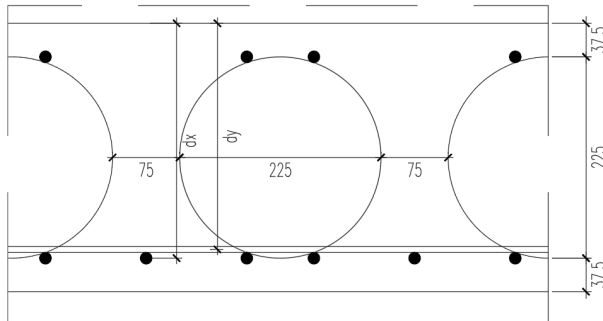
21. Detail BD280 Lajur Kolom Lapangan Arah X
